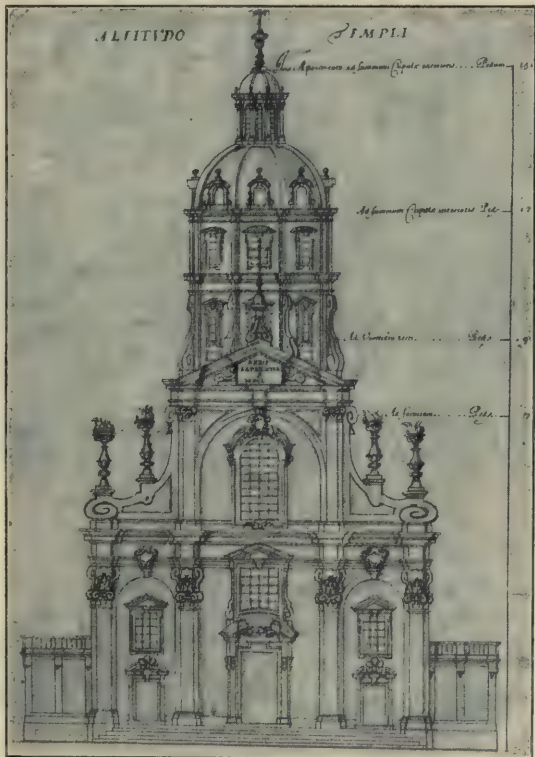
Löwen. Jesuitenkirche. Fassade.
